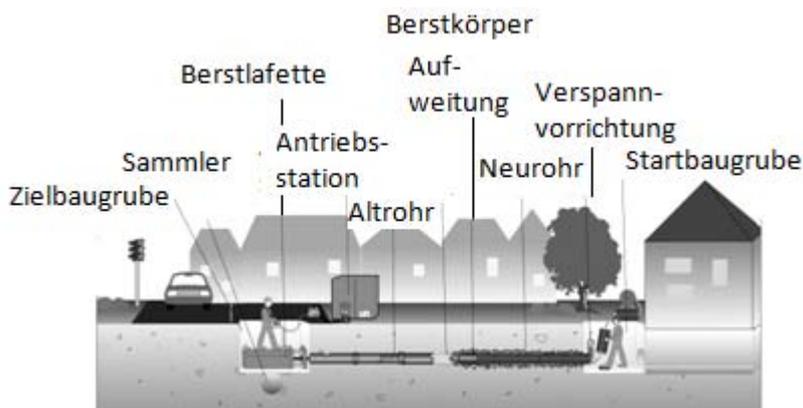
7: Systemaufbau des statischen Berstens von Anschlussleitungen
